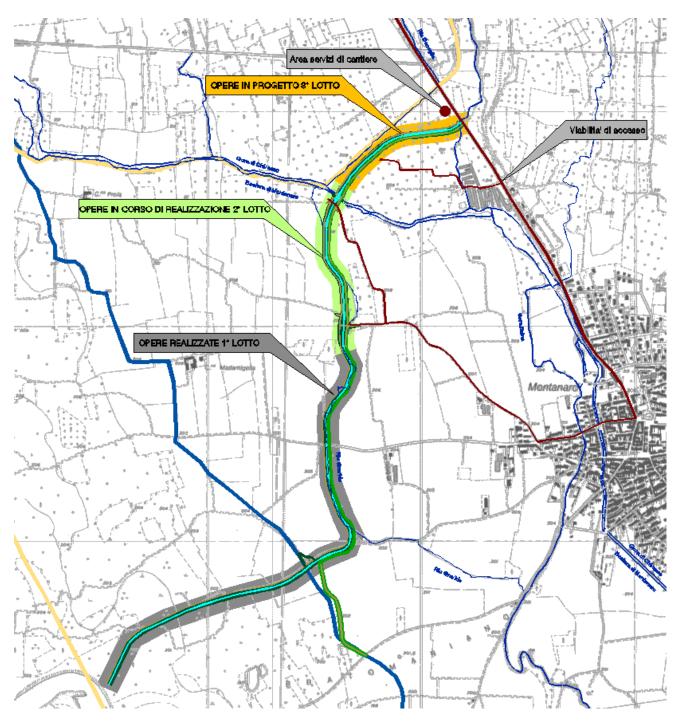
Area di intervento, area di cantiere fissa e principali vie d'accesso
